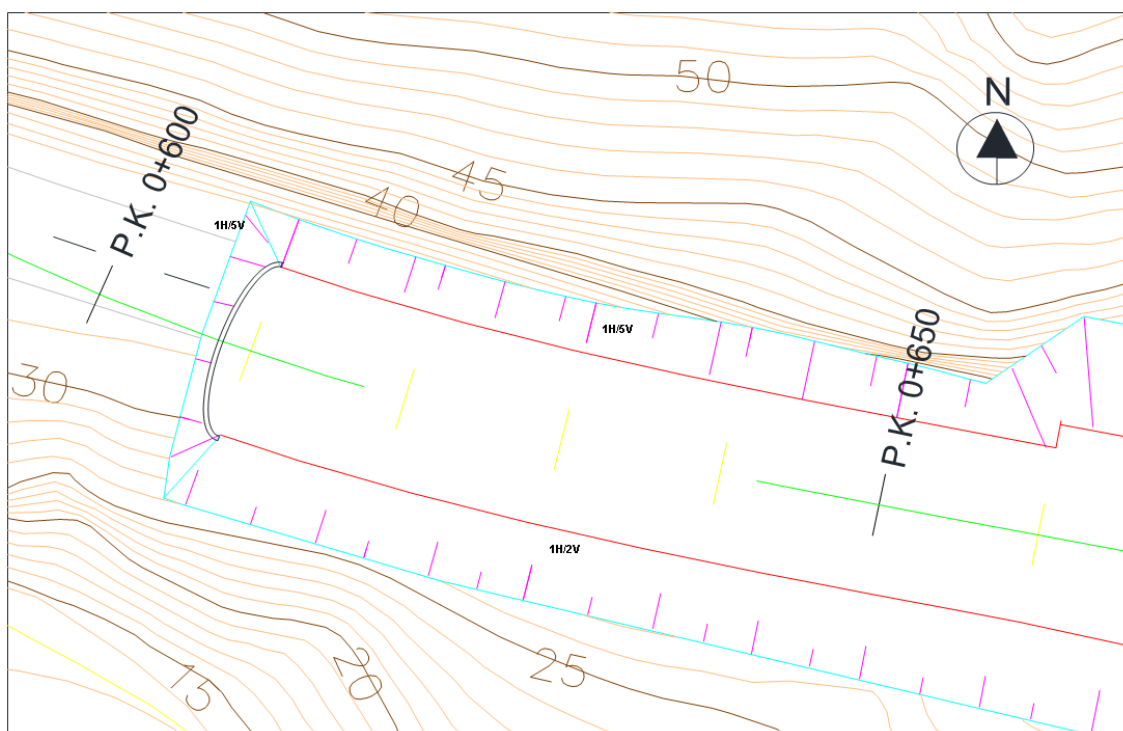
Planta de la trinchera prevista en el proyecto de variante de la GC-500 entre el barranco de Amadores y el de El Lechugal.
